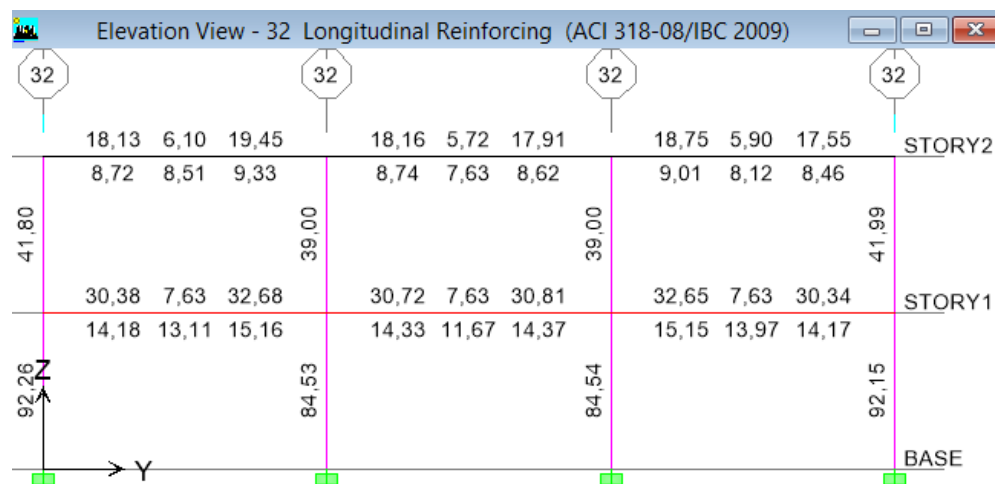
Acero en Vigas y Columnas en el Pórtico 32 – Obstetricia- (NEC-11)
